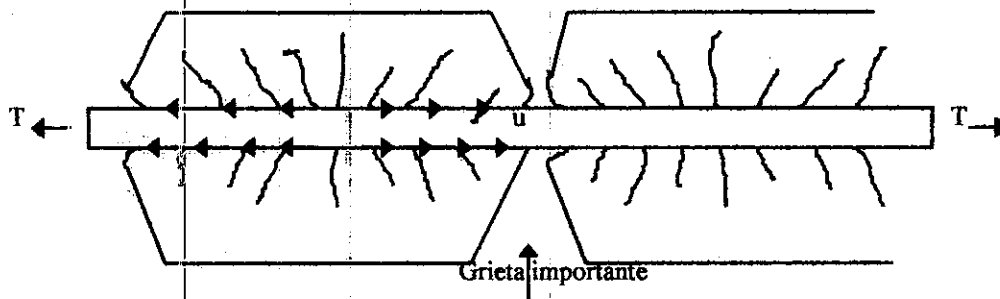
Concreto deformado entre grietas transversales de un miembro en tensión.
